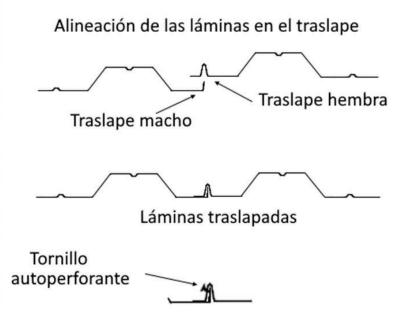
Colocación de las láminas de SteelDeck para construcción de losa
